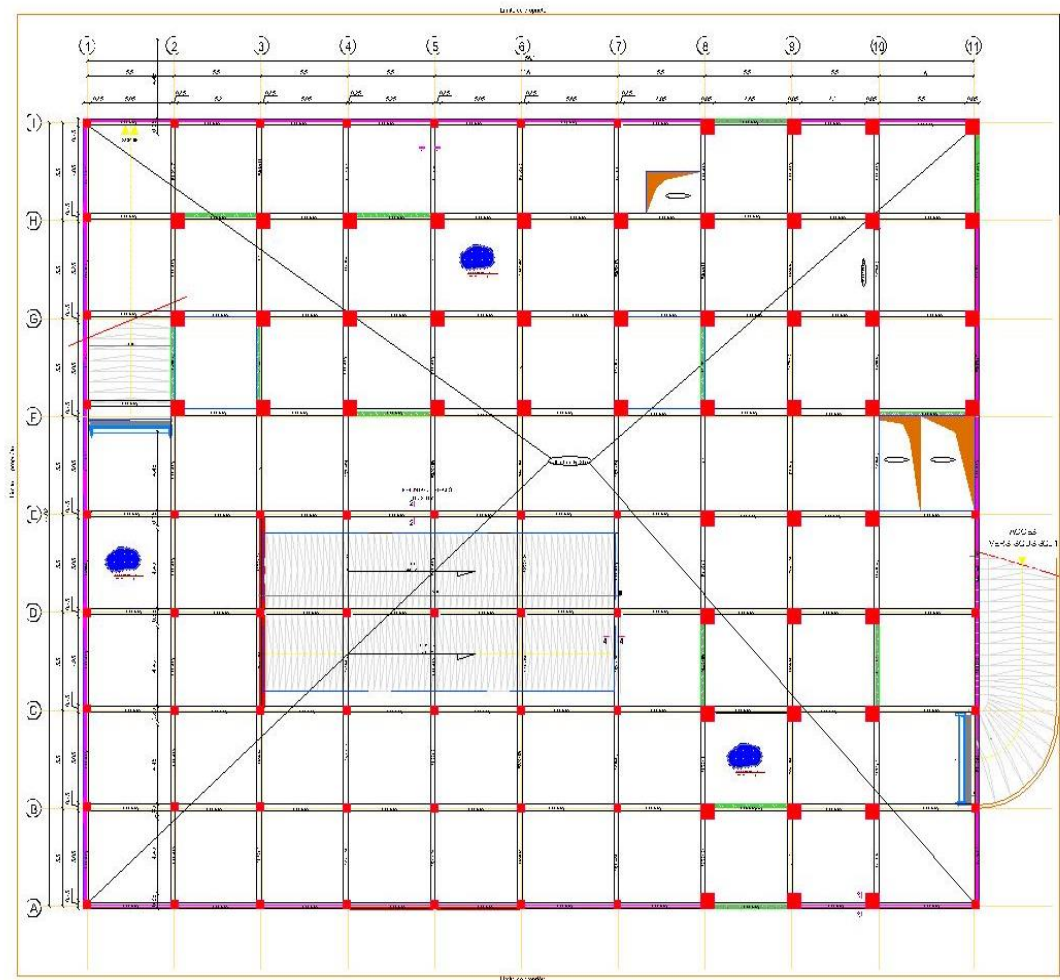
Plan de coffrage (sous-sol 1 / 2)
